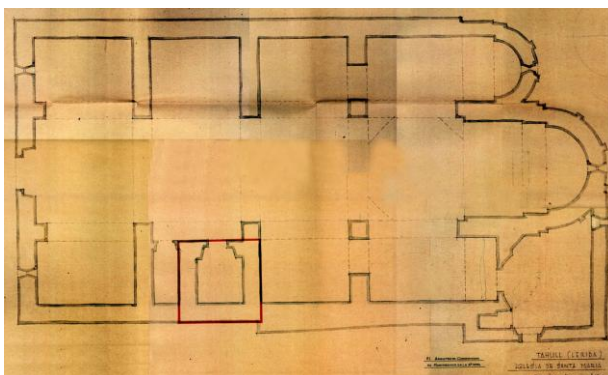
Taull. Iglesia de Santa María AAFV. Plano de proyecto, planta anterior a la demolición de la sacristía moderna
